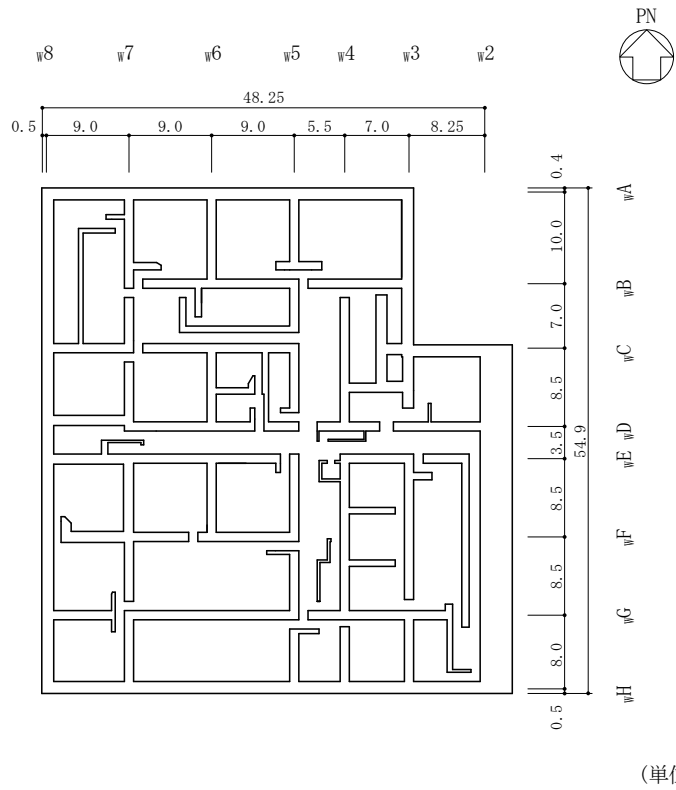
(1) 廃棄物処理建物の概略平面図 (EL 3.0m*)
